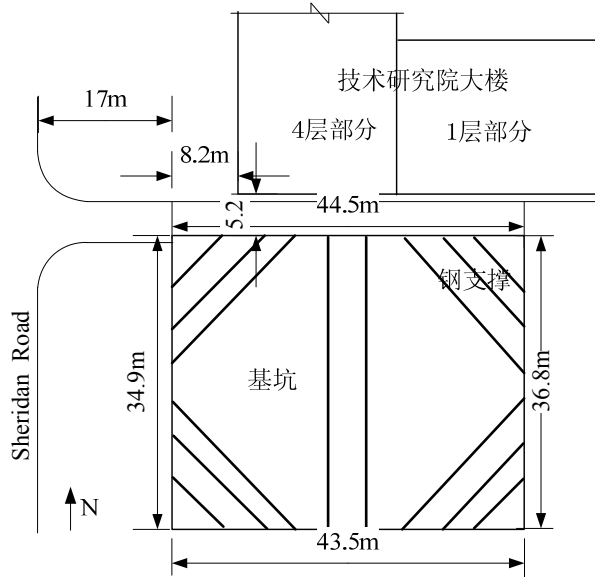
福特汽车公司工程设计中心基坑工程平面图
